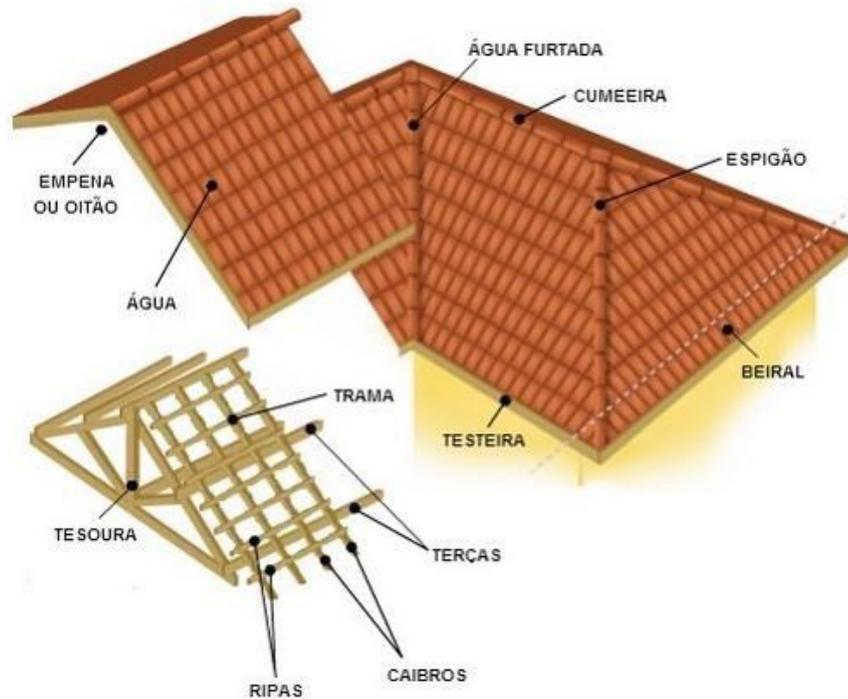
Detalhamento típico de um telhado com estrutura em madeira
